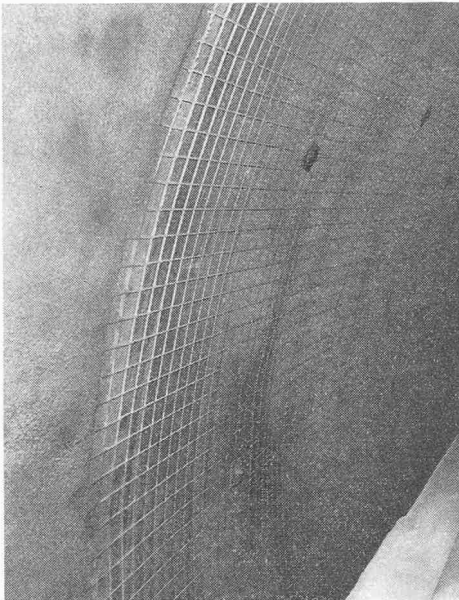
Ankerung, Bewehrungsnetze und erste Lage Spritzbeton an den Ulmen
